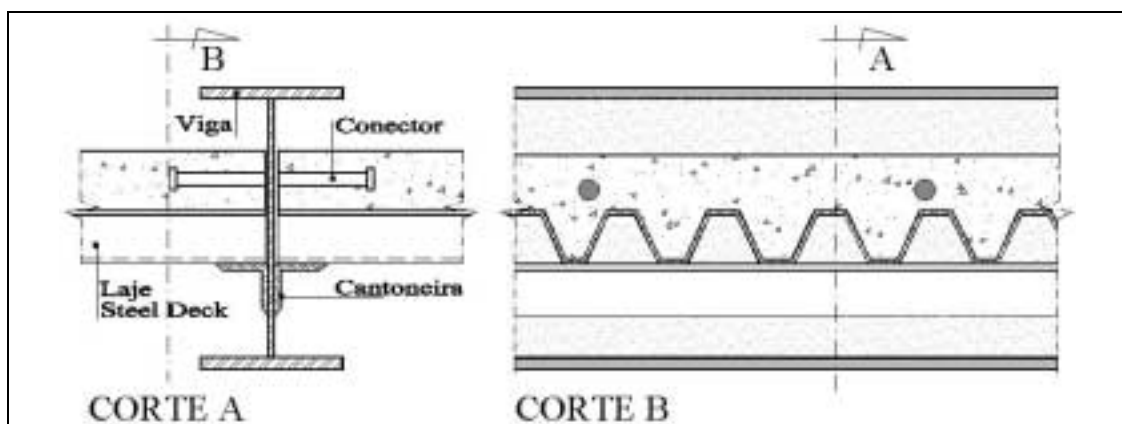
Detalhe esquemático de adaptação da estrutura para a saída dos dutos de ar-condicionado da casa de máquinas, no pavimento-tipo.
